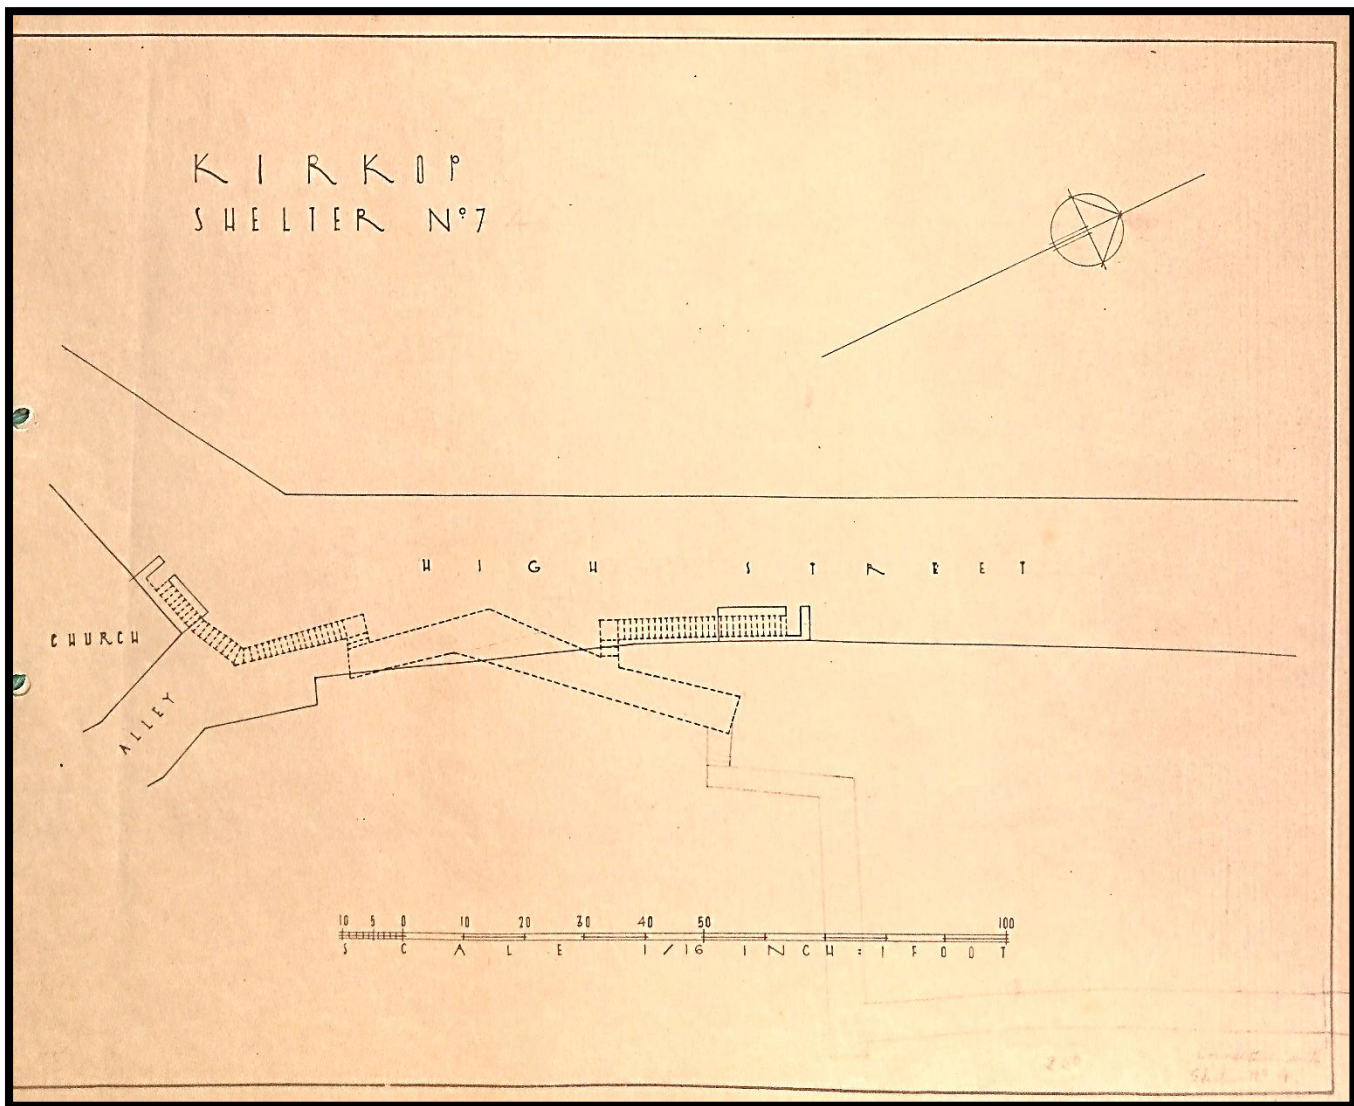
Planta do Abrigo nº7 "Church Alley – High Street."
